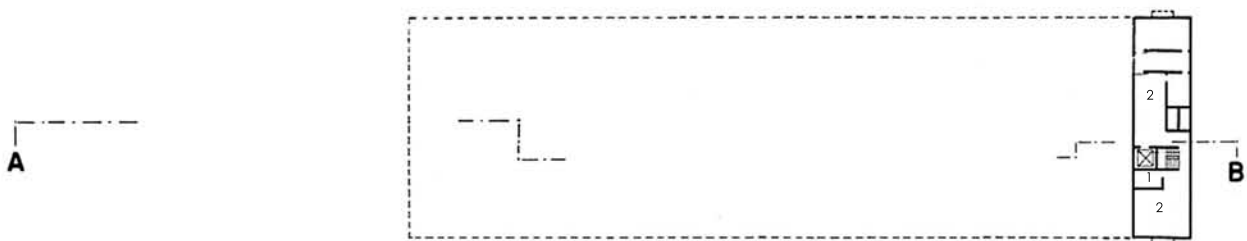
PALÁCIO DOS ESTADOS - SUBSOLO - PLANTA BAIXA
